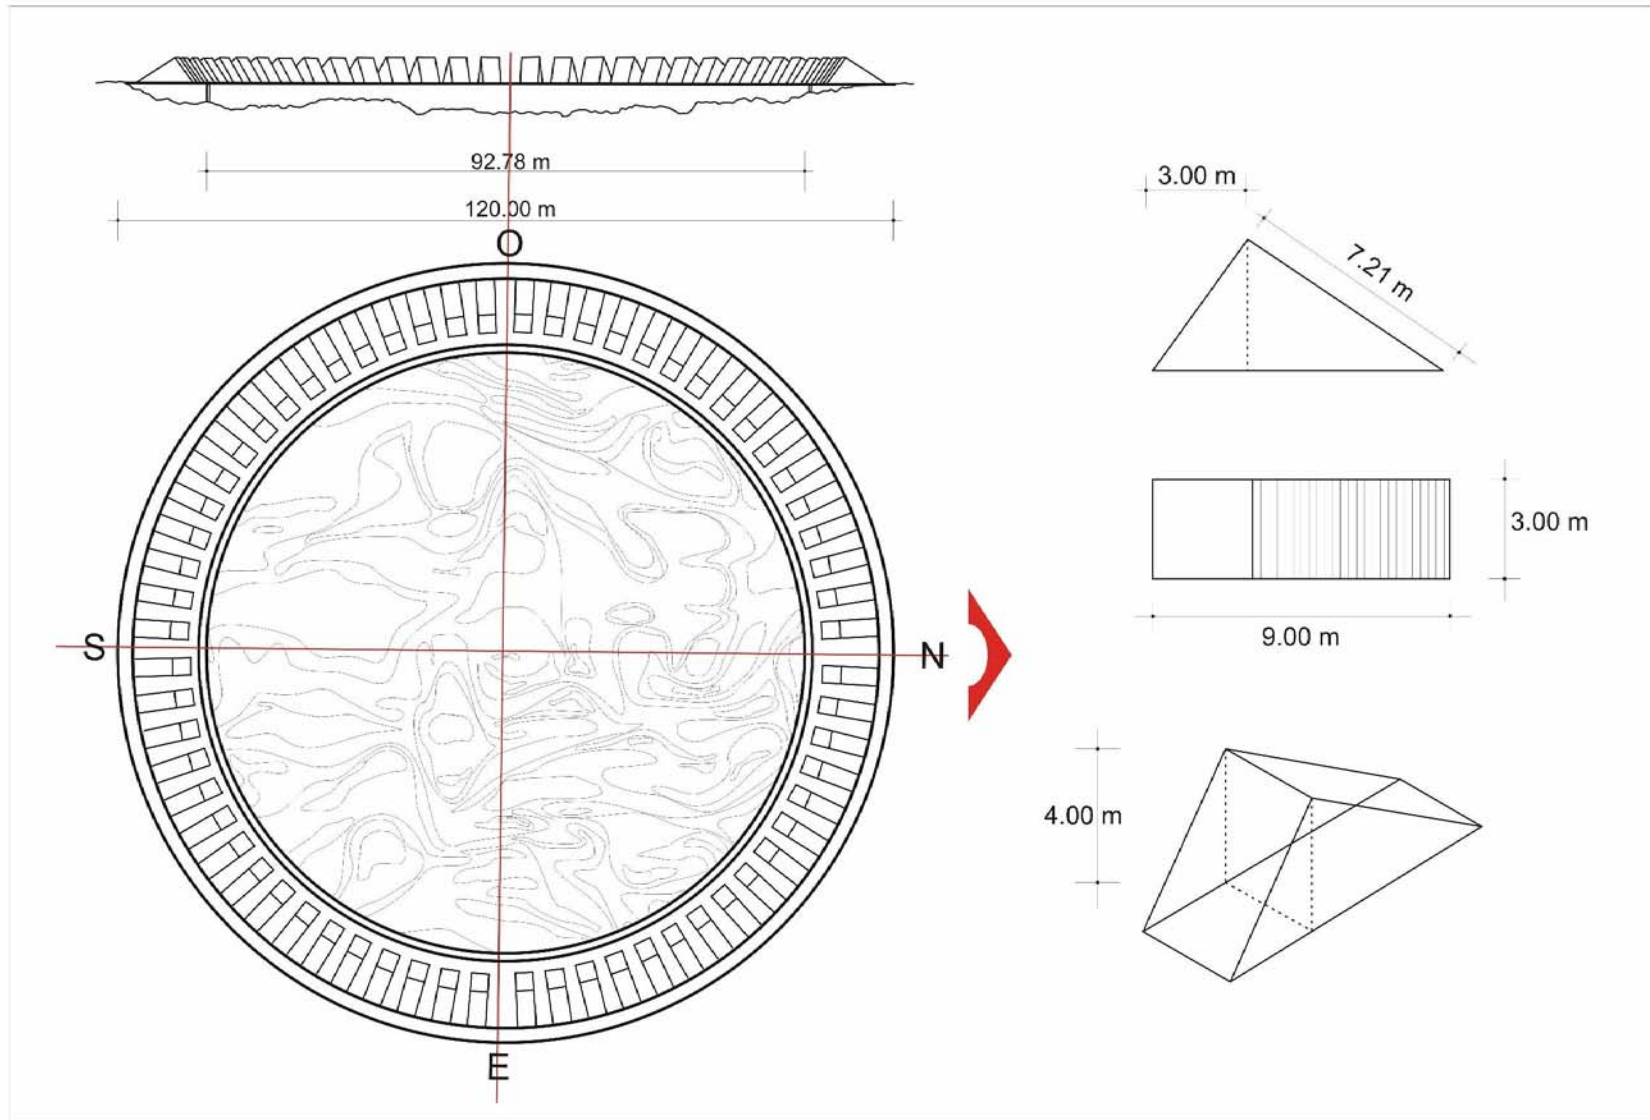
Planta , alzado y detalles del *Espacio Escultórico*.
